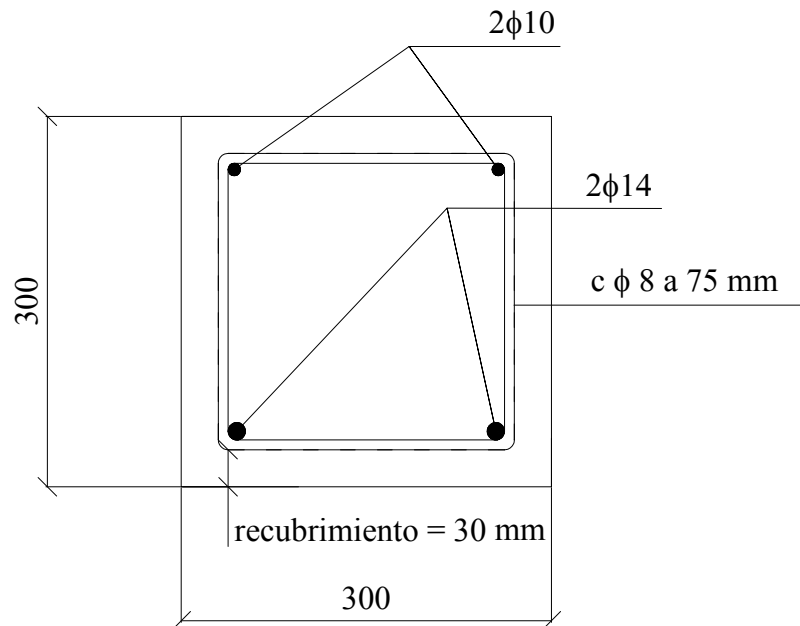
Sección tipo de viga de hormigón armado. Cotas en mm.
